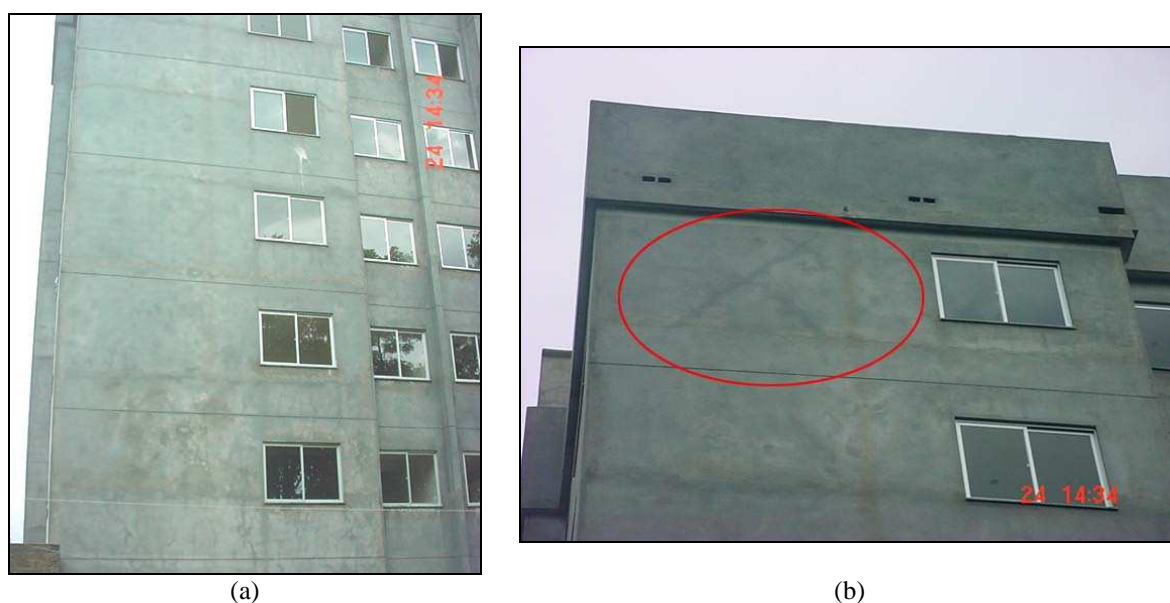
Fissuras geométricas observadas em todos os pavimentos: (a) vista geral do edifício e (b) fissuras nos últimos pavimentos.
